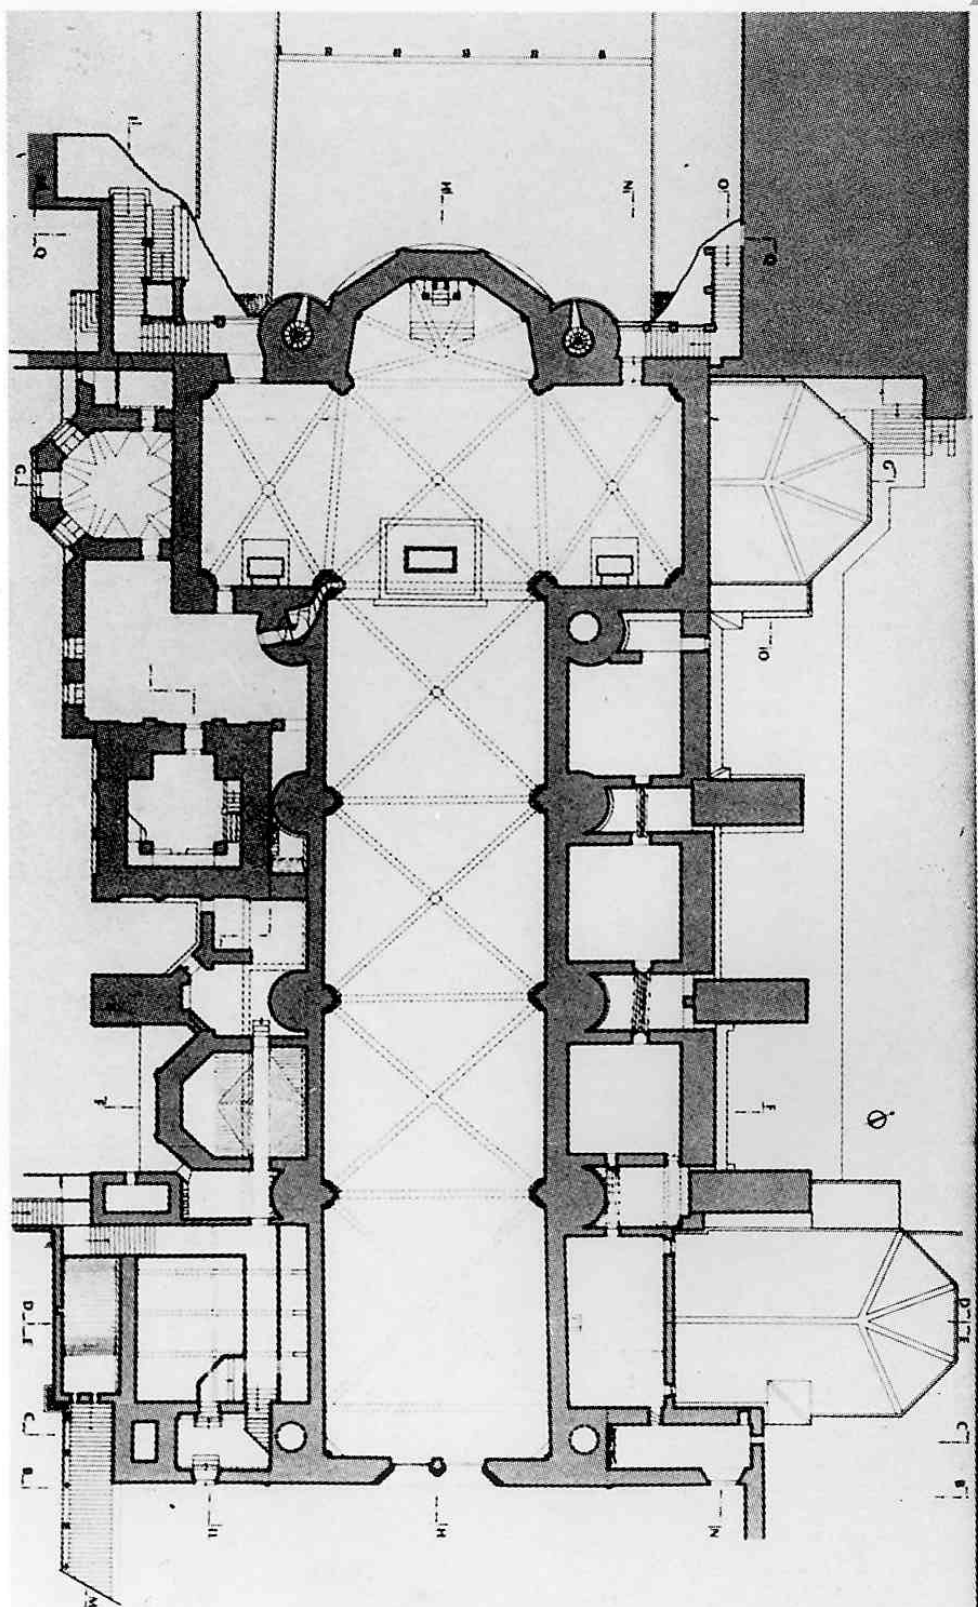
San Francesco in Assisi, Grundriss der Oberkirche
